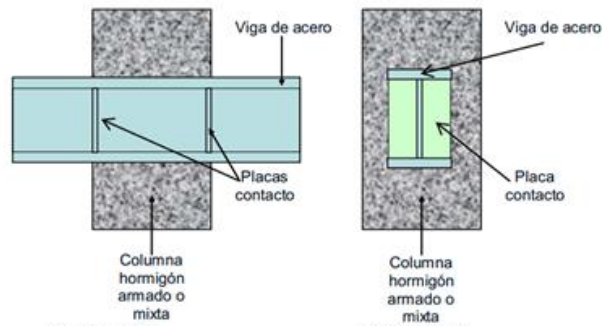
Conexión viga de acero a columna de hormigón o columna de acero embebida en hormigón. Nota. Dato tomado de ACI 318-05
